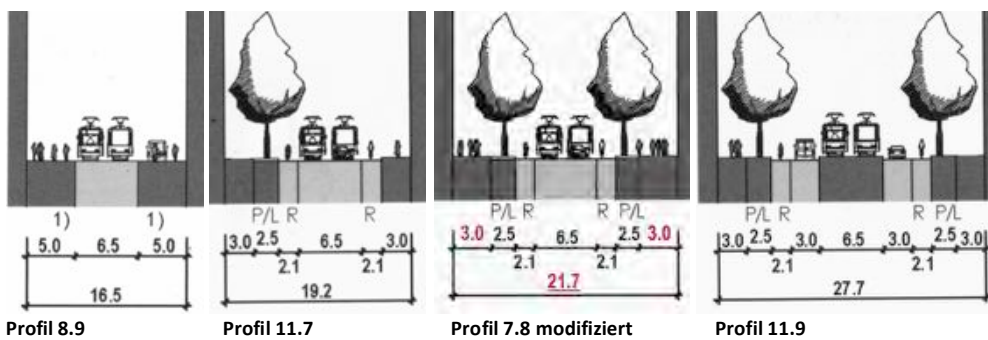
Detail Entwurfsschnitte der RAST06. Im modifizierten Profil 7.8 (Mitte) wurden die Gehwege – wie in einer Verkehrsstraße üblich – mit 3,0 m ausgeführt. Profil 8.9 (links) stellt eine Fußgängerzone dar, Laden und Liefers finden im Seitenraum statt. Ein besonderer Bahnkörper ist erst ab etwa 28 m Raumbreite möglich.
